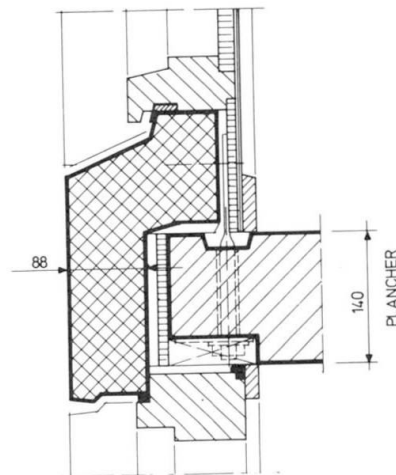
COUPE VERTICALE ELEMENT DU FAÇADE
